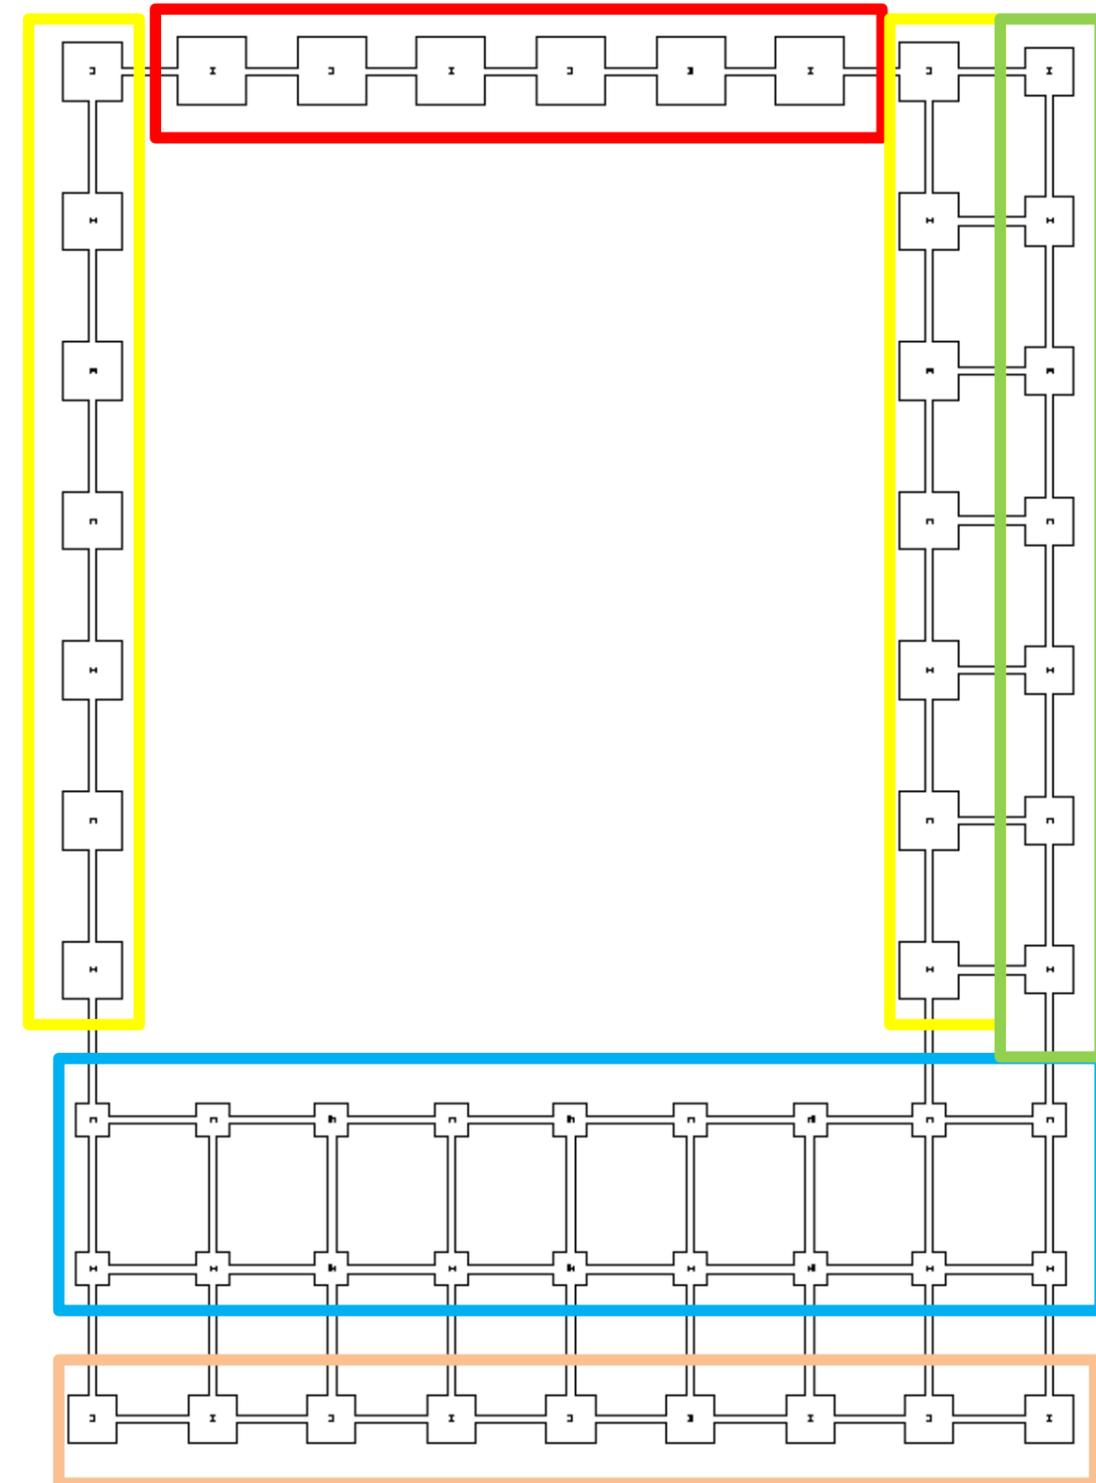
Vista en planta de la cimentación. Diferenciación en colores en función del tipo de zapata
